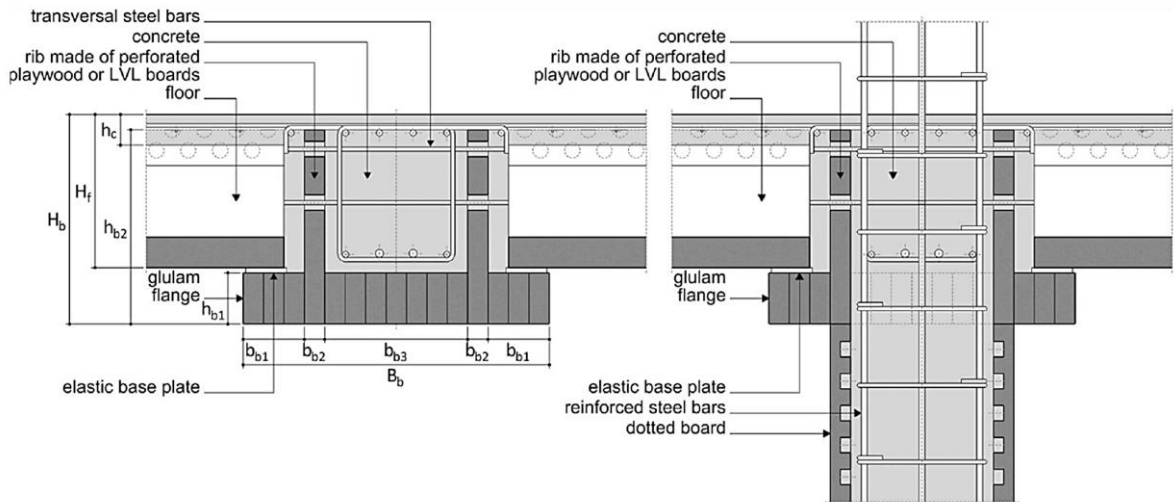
Coupe transversale de la poutre avec support de plancher: la liaison poutre-poteau [12]
